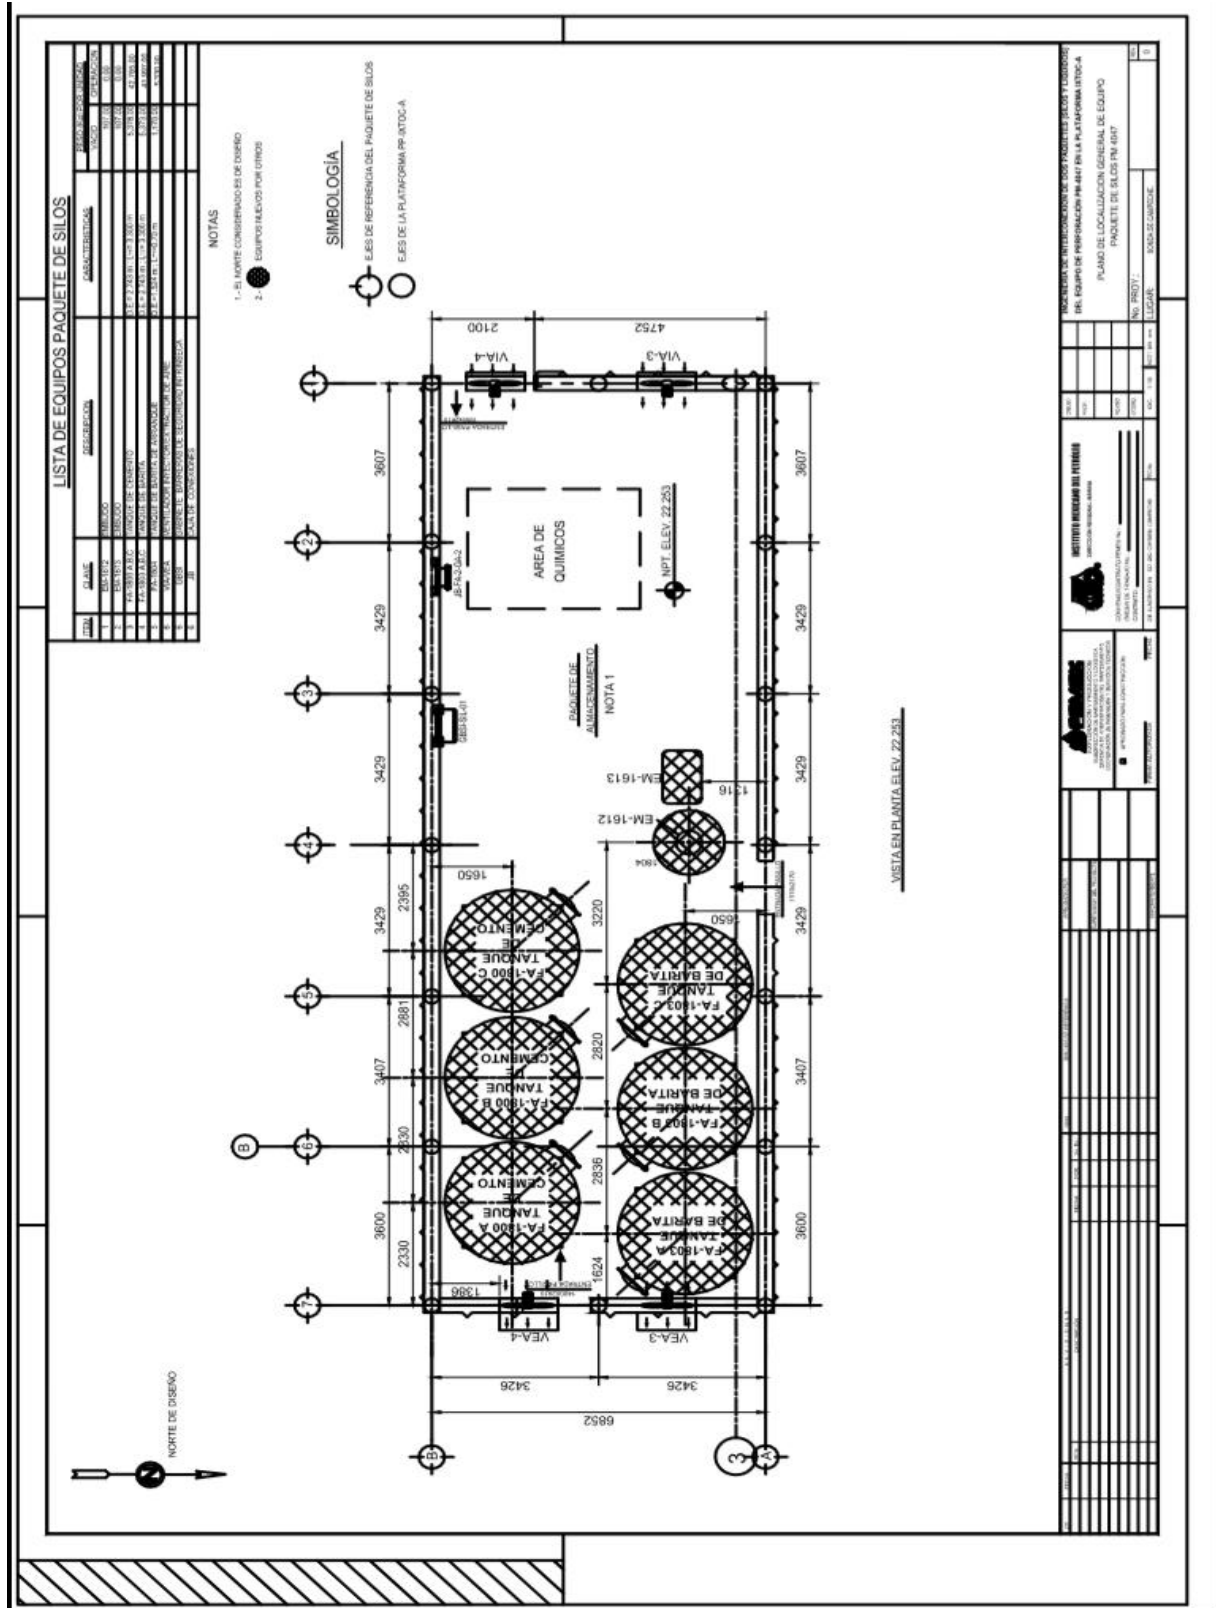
Plano de Localización General (PLG) Paquete Silos.
